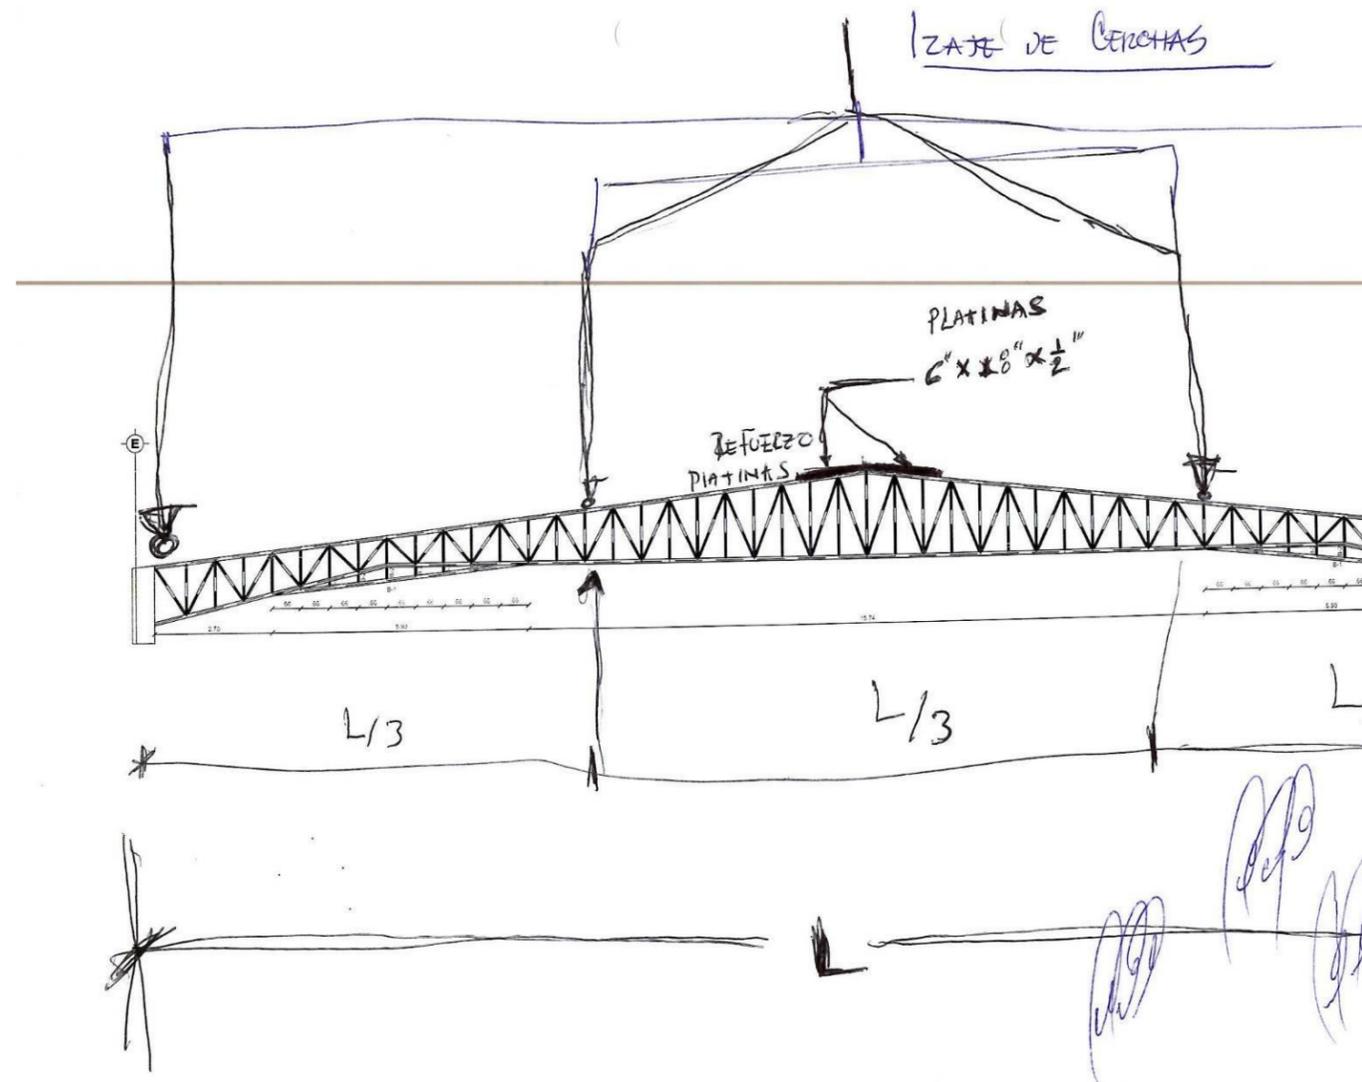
Boceto de refuerzo de platinas en las cerchas, elaborado por la Practicante.
